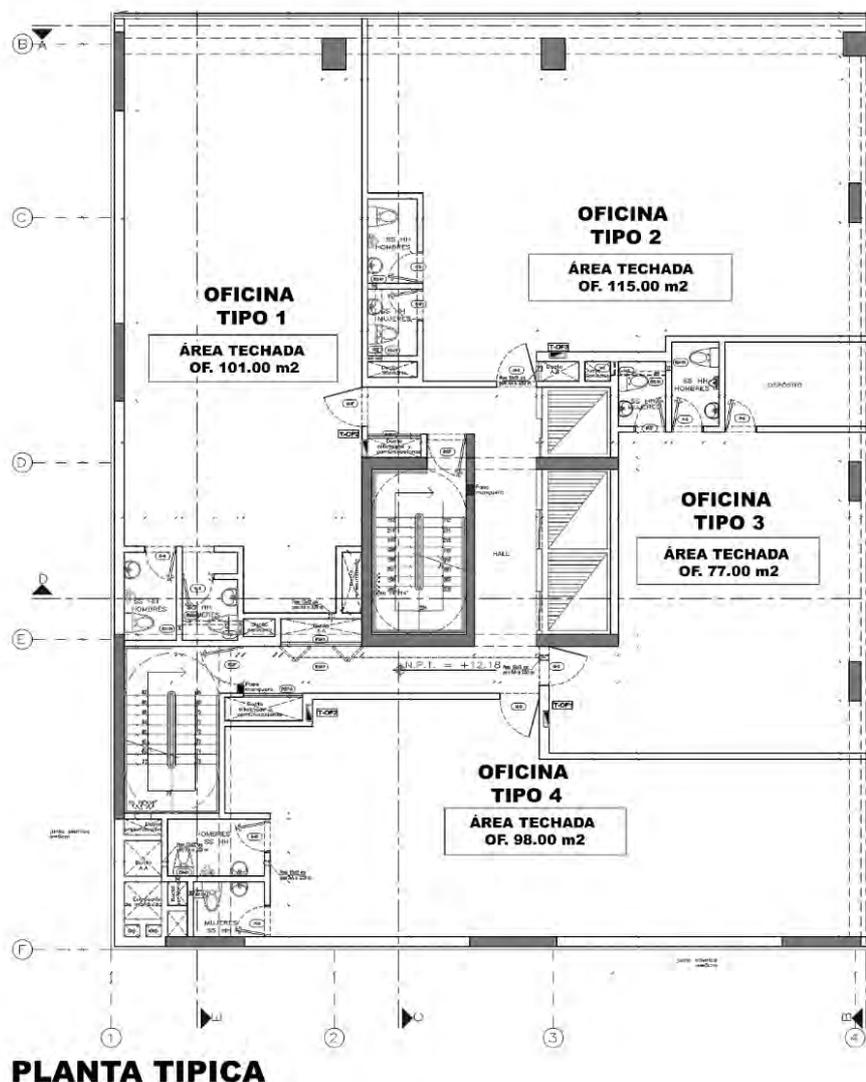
Planta de distribución de torre de oficinas (Fuente propia).
